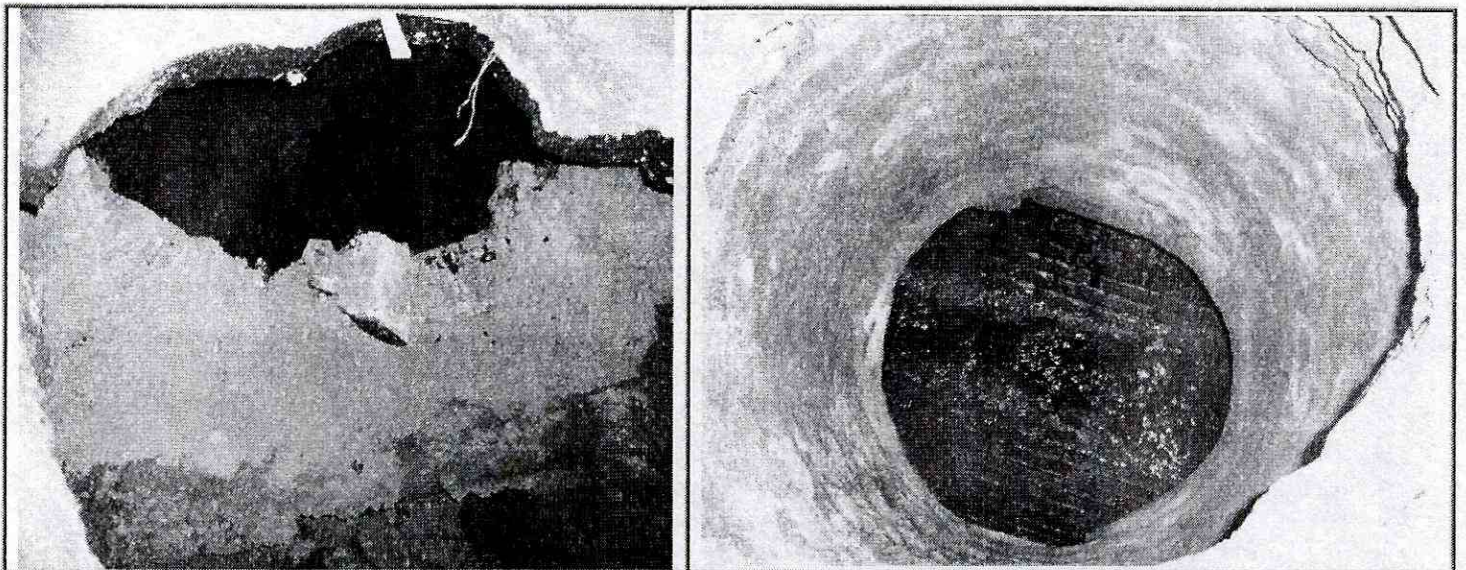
Estructura en concreto por donde transcurren aparentemente ductos de teléfonos.
